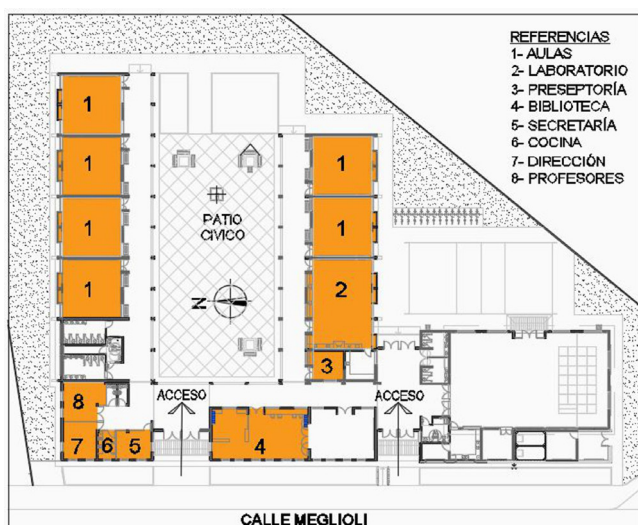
Planta CPR con indicación de espacios calefaccionados.
